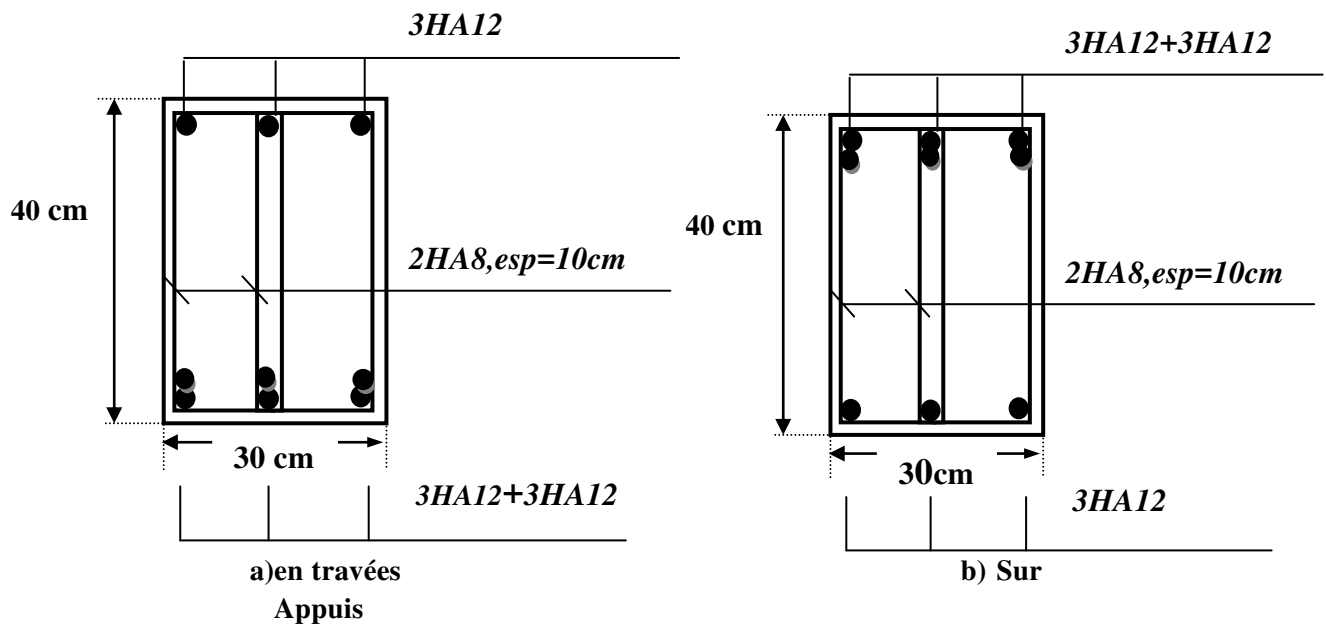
schéma de ferrailage des poutres principales (30x40)cm²
